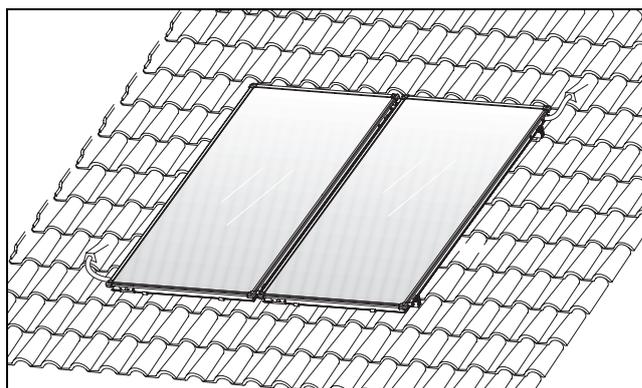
Vista completa della coppia di collettori, montaggio sopra tetto
